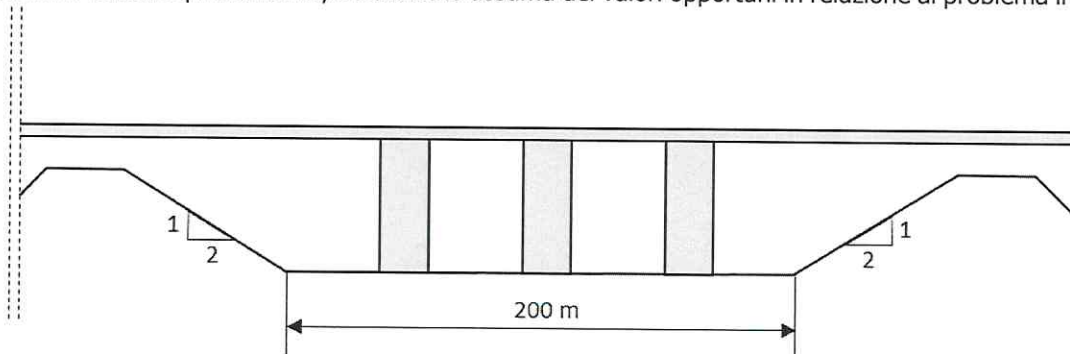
Sezione trasversale dell'alveo in prossimità dell'attraversamento.
